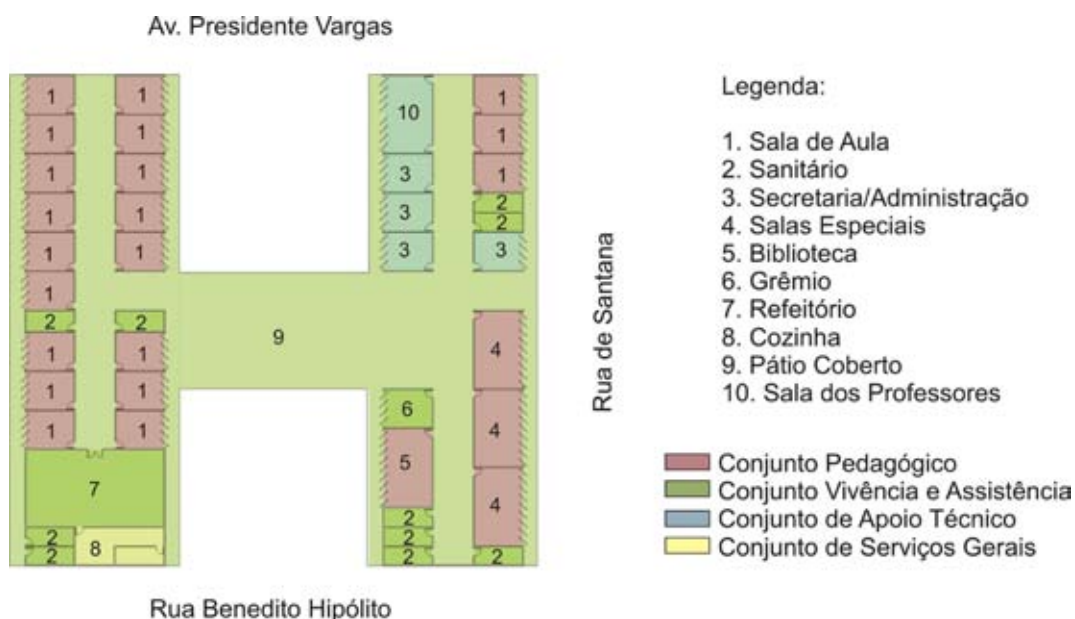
Planta Esquemática da antiga E. M. Tia Ciata.
